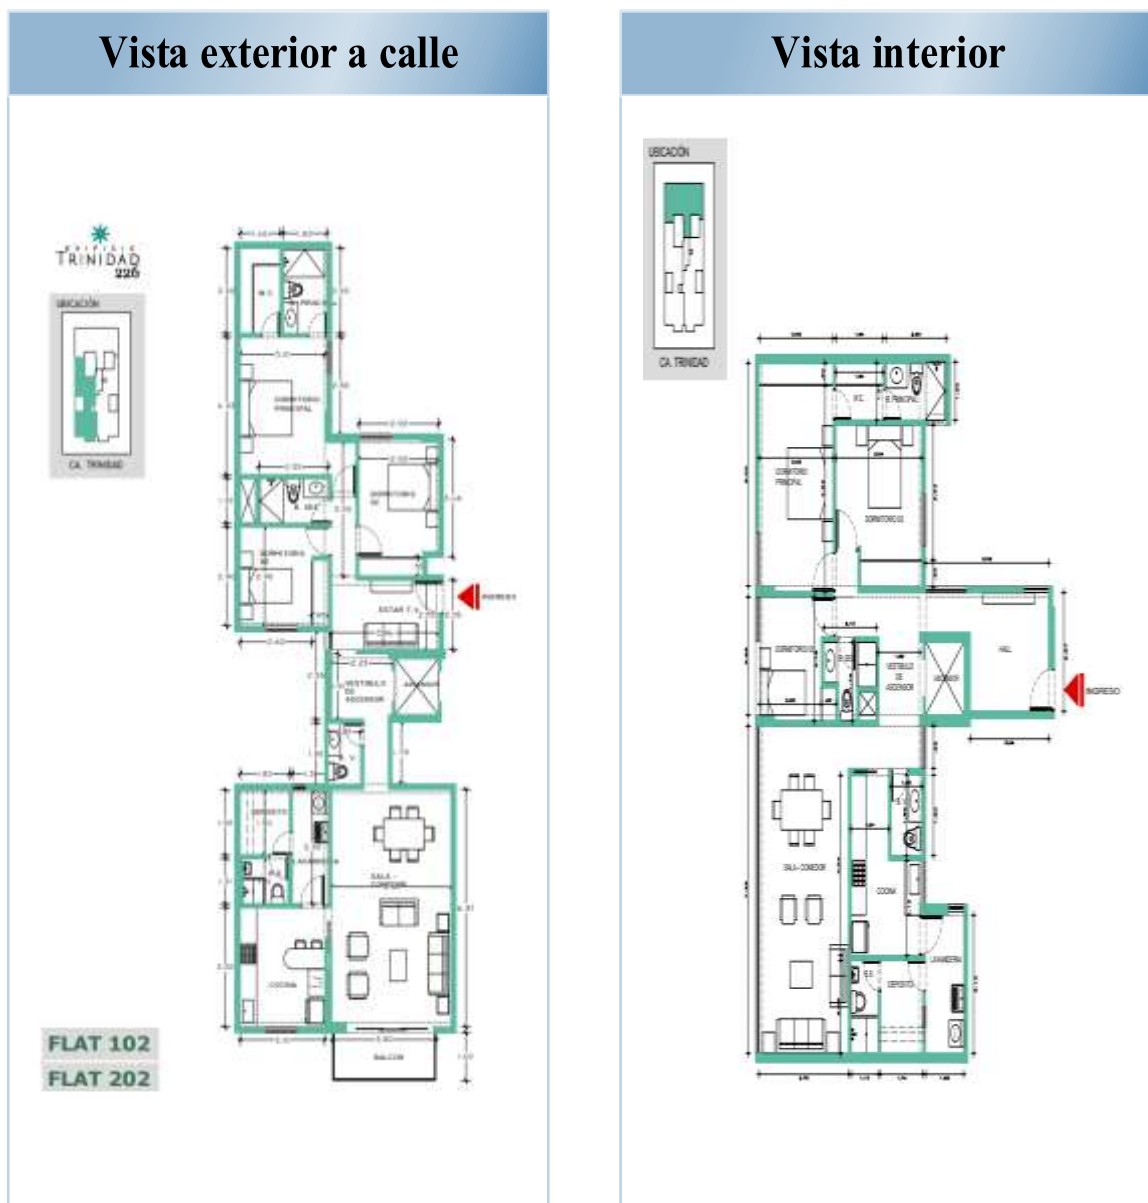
Planta de departamentos con vista interior y exterior (adaptado de: Urbania)
